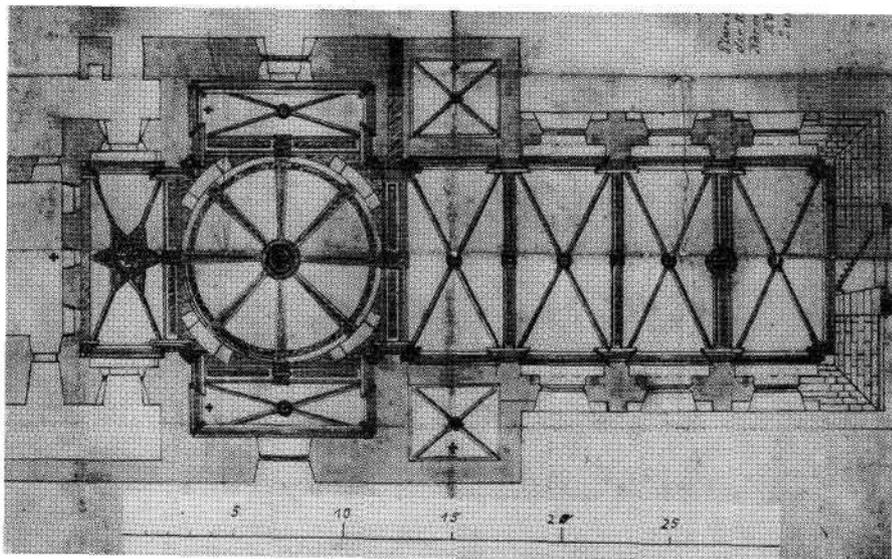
Köln, Grundriss der ehemaligen Klosterkirche „Im Dau“.
